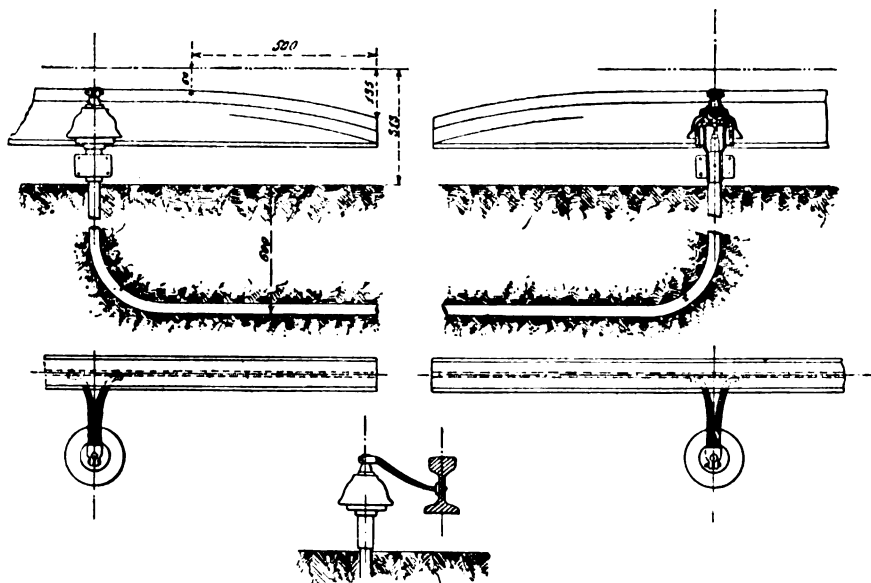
, 14, 15 e 16. - Connessione della terza rotaia nei passaggi a livello, scambi, ecc. — Prospetto, pianta e sezioni.
